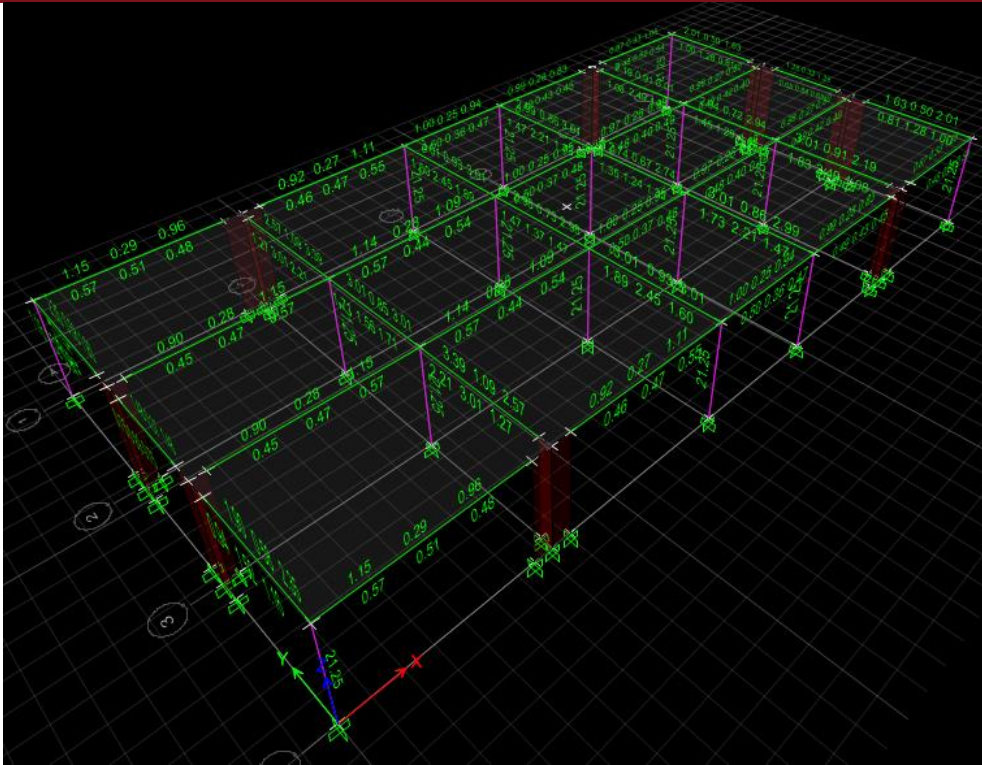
Acero requerido para los elementos estructurales del módulo 02
